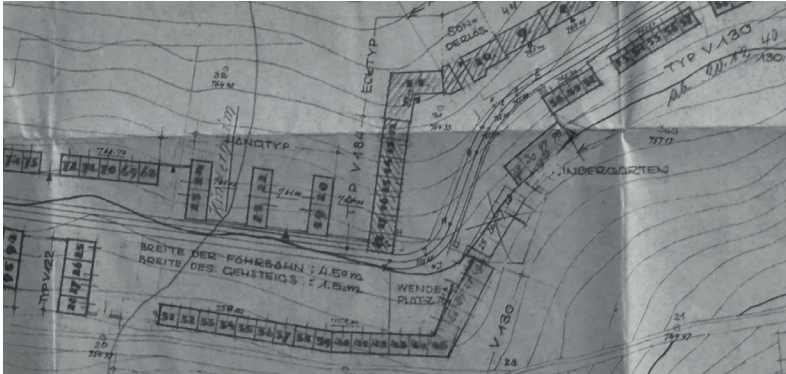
Büro Herbert Rimpl, Lageplan mit Höhenlinien, 1940
